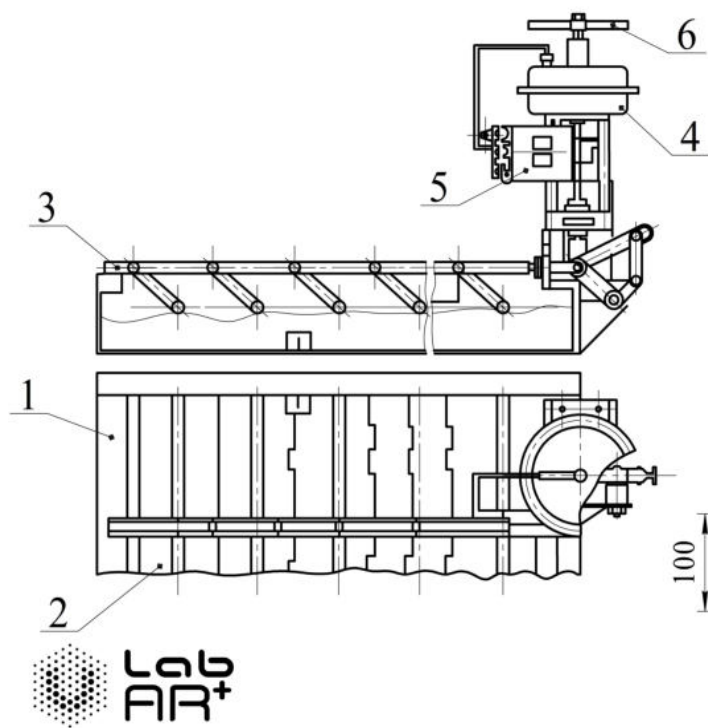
Жалюзійна решітка: 1 – рама; 2 – лопать; 3 – тяга; 4 – пневмопривод; 5 – позиціонер; 6 – ручний дублер
